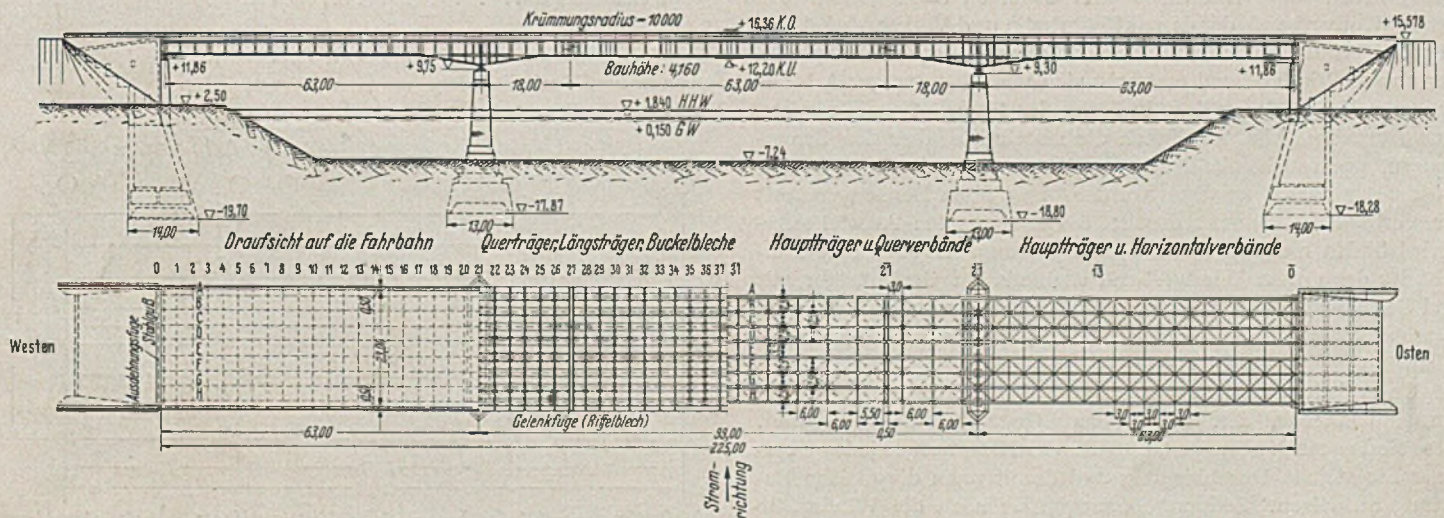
Ausführungsentwurf. (Längsschnitt und Grundriß.)
